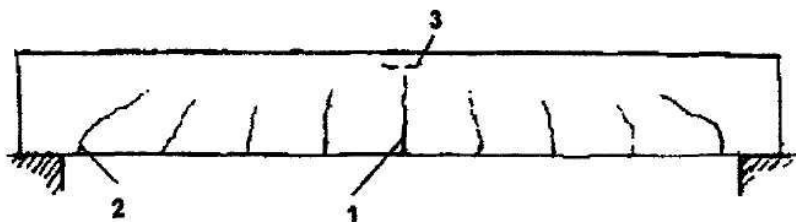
Схема трещин в статически определяемом изгибаемом железобетонном элементе:
